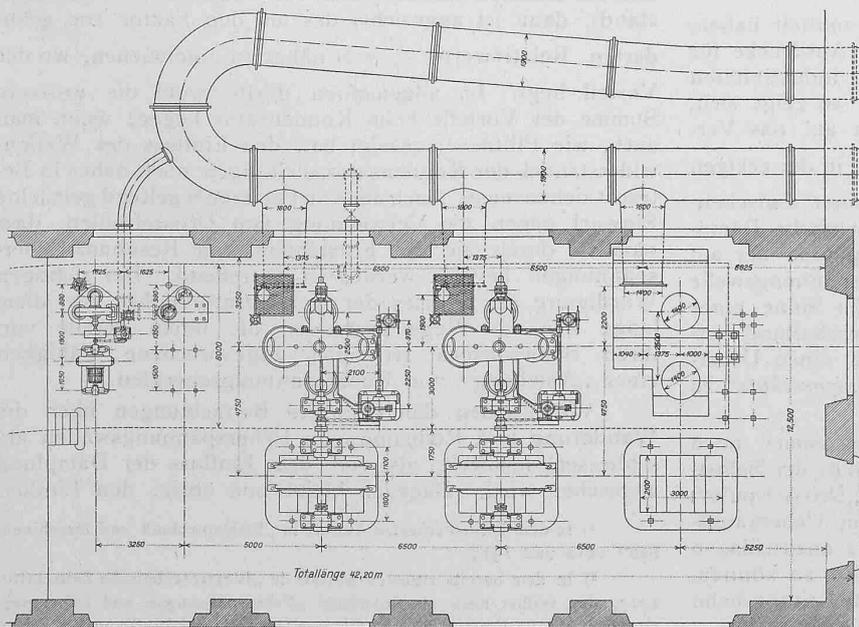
Grundriss der Zentrale Pedesalto. — Masstab 1 : 250.
